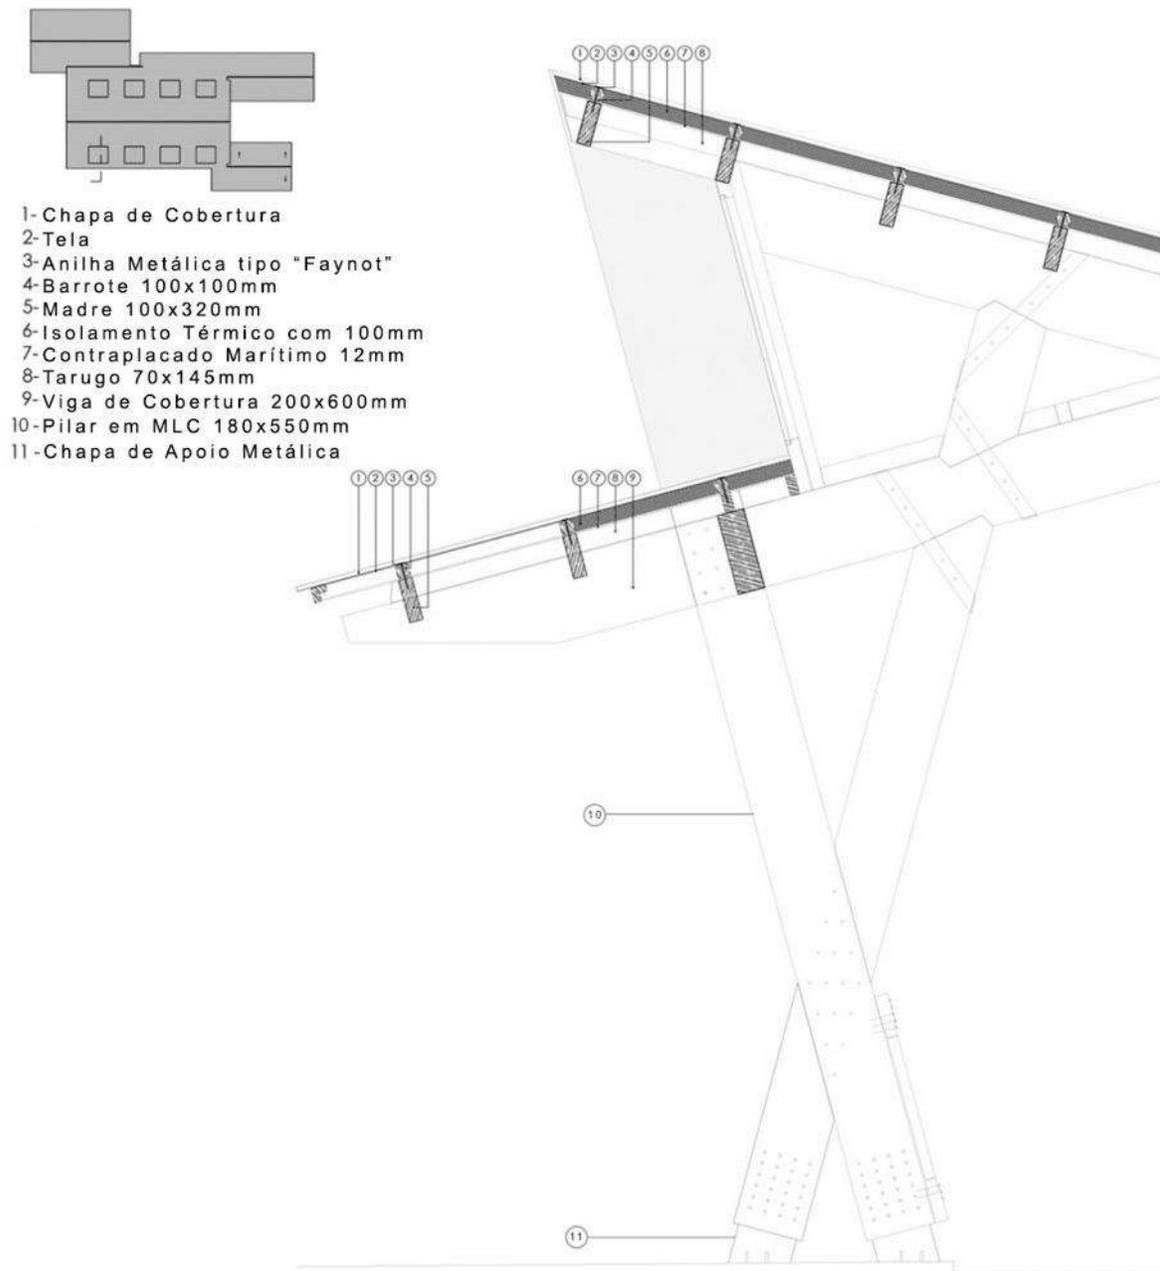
Corte mostrando o detalhamento construtivo da estrutura em Madeira Lamelada Colada junto à cobertura. (fonte: Carlos Castanheira)
